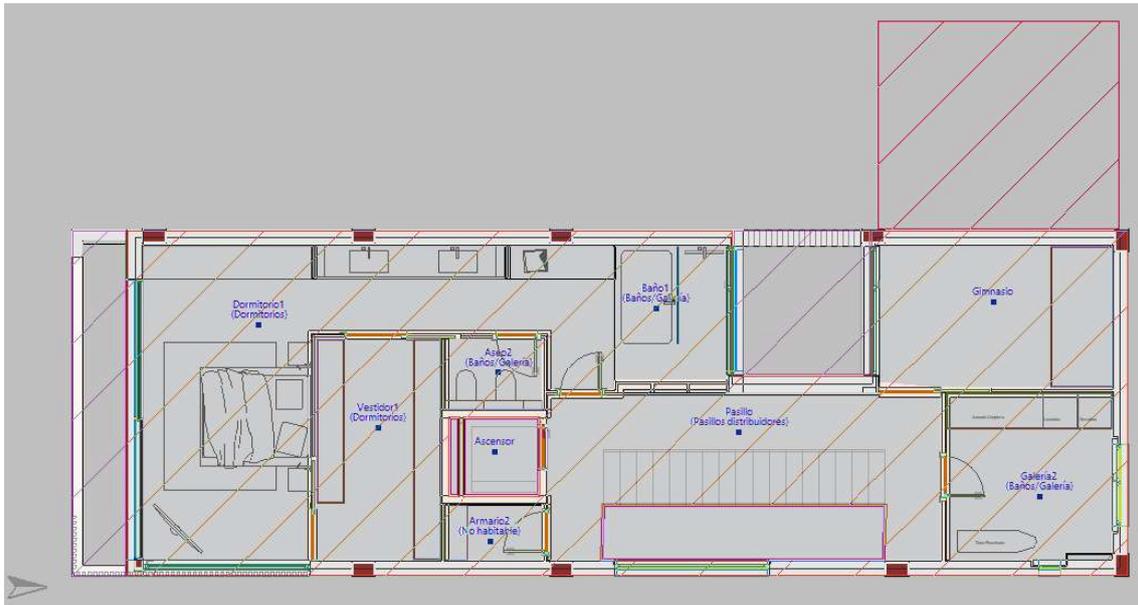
Distribución Planta Primera. Vista: En Planta. IFC Builder
